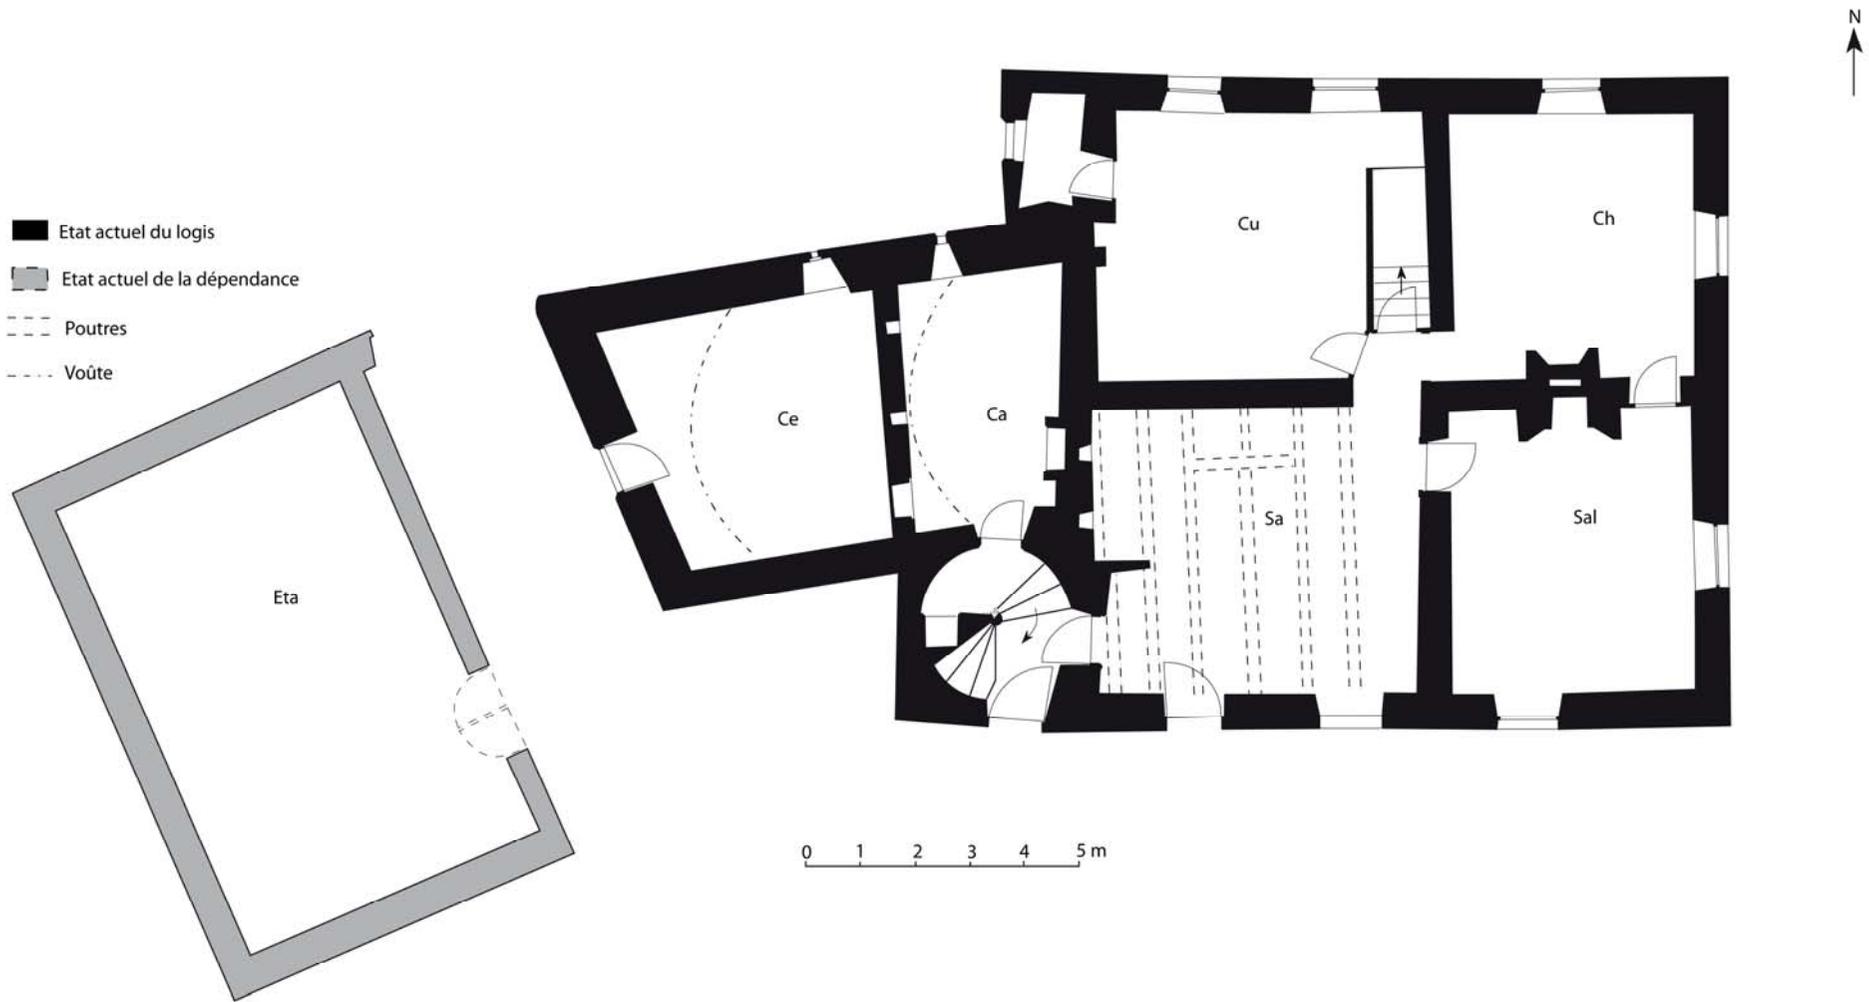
La demeure, plan du rez-de-chaussée, état actuel.
